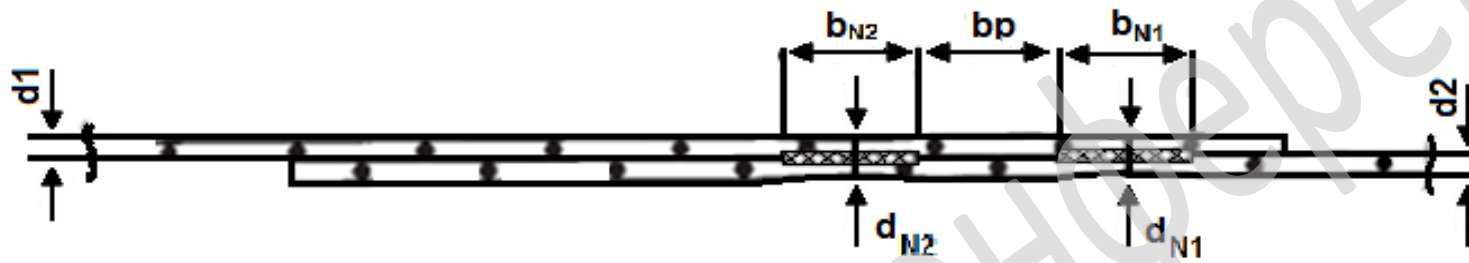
Форма и размеры сварного шва с проверочным каналом
